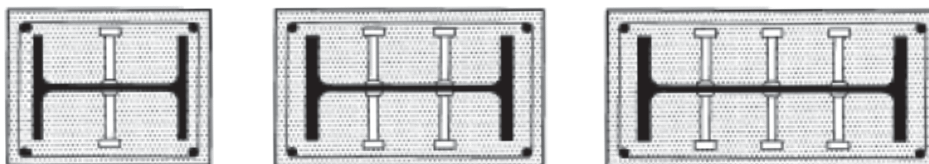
Disposizione dei pioli per la connessione meccanica acciaio-calcestruzzo
